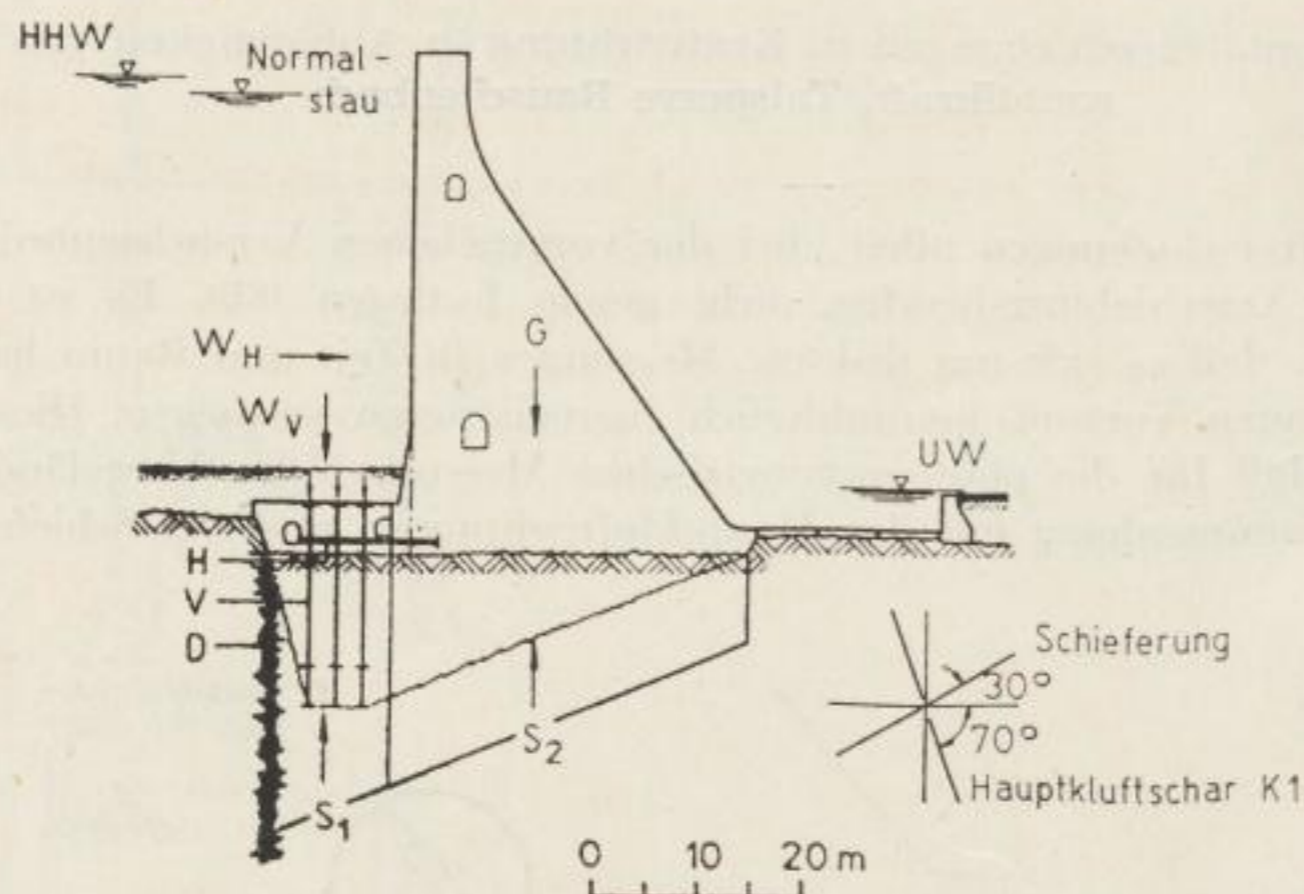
Mauerquerschnitt mit Schleppplatte, Talsperre Rauschenbach
